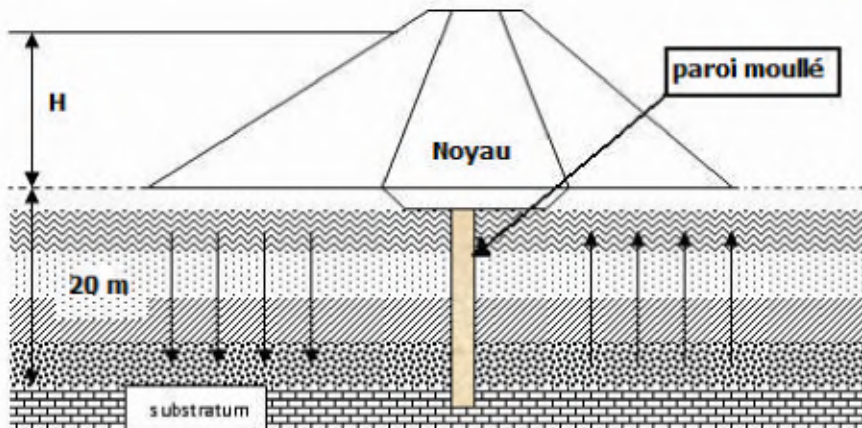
Infiltration à travers la fondation avec le paroi moulée.
